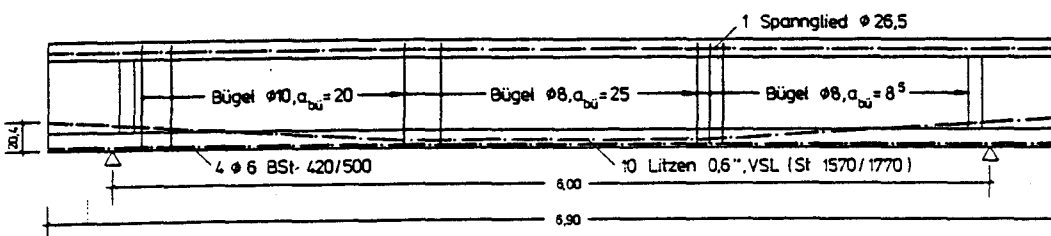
Abmessungen und Bewehrung der Balken B4 - B8
